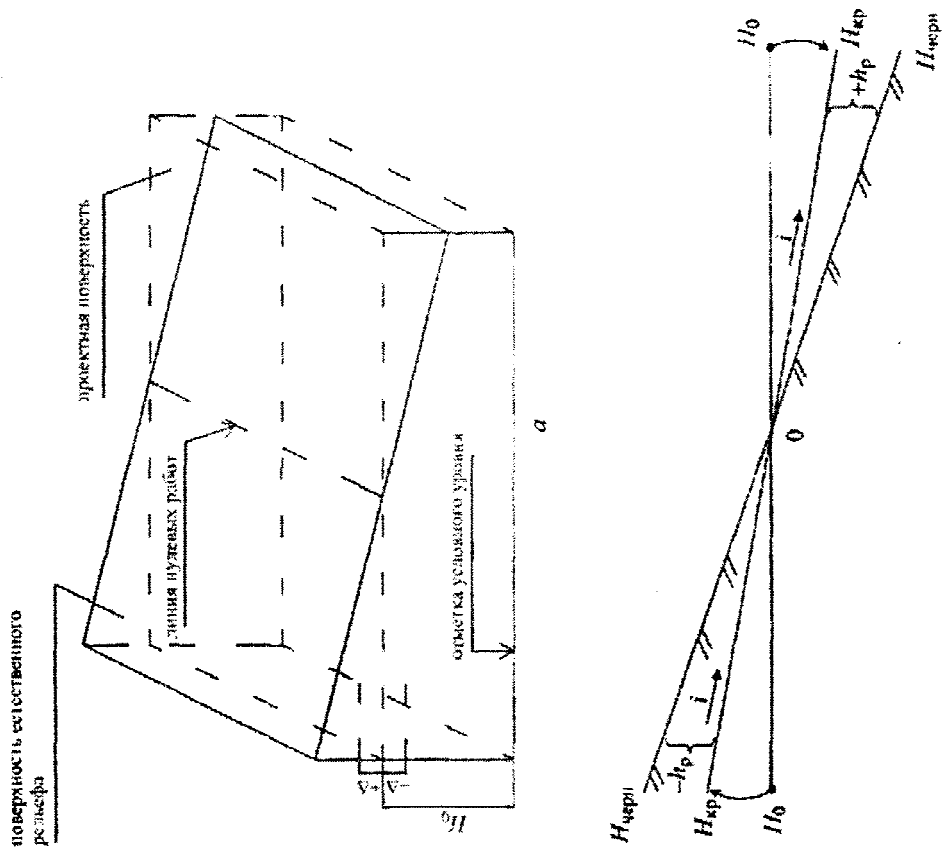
Схема вертикальной планировки площадки: а - в виде объемной призмы, б - в разрезе планируемой площадки
